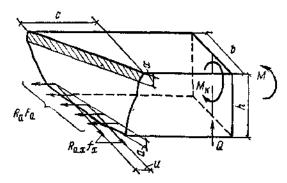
Схема усилий в пространственном сечении железобетонного элемента при расчете его по прочности
